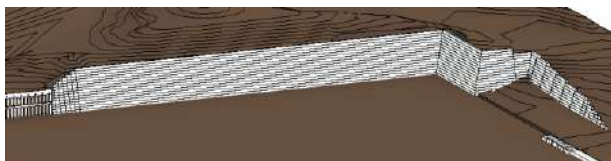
Perspetiva tridimensional do Muro de gabiões.
